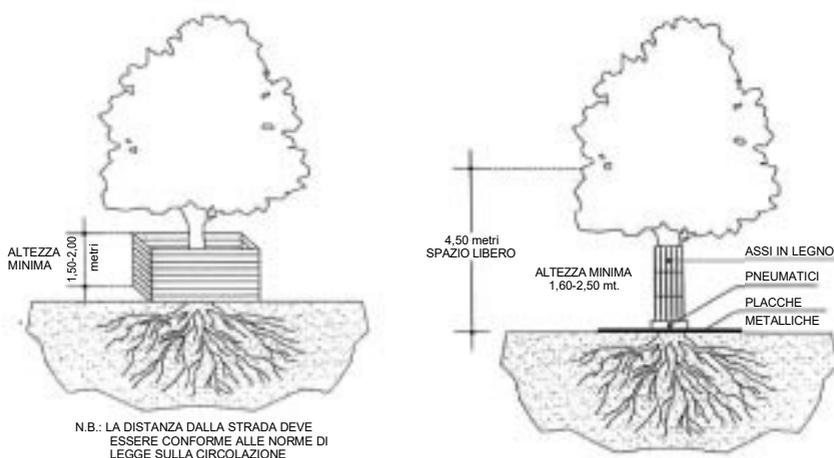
Protezione dell'albero in caso di alberature stradali con poco spazio, attraverso la delimitazione dell'area minima di rispetto.
